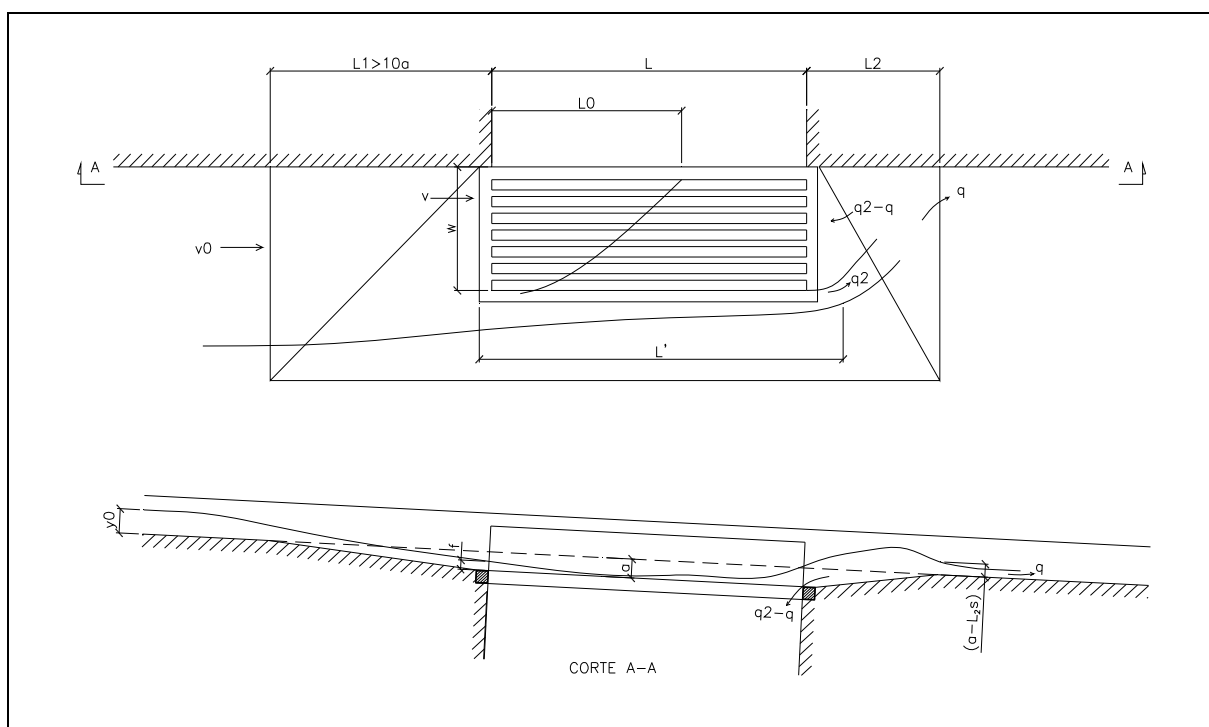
Boca-de-lobo combinada, padrão Universidade de Johns Hopkins
